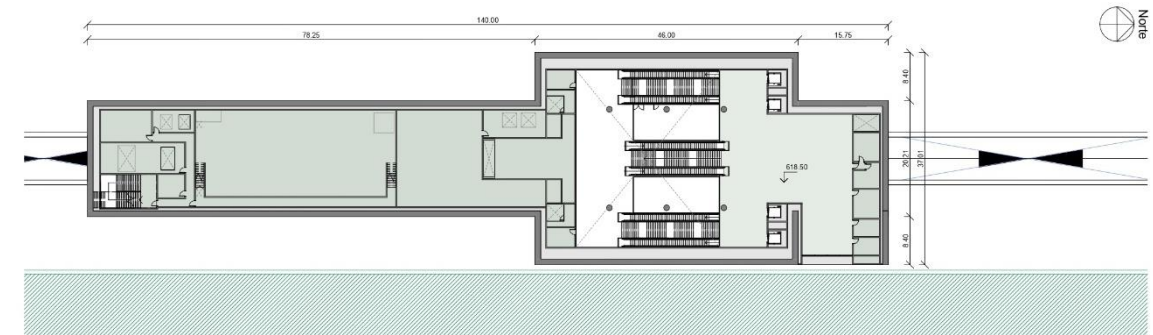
Estación Barajas T4 _Planta Vestíbulo
